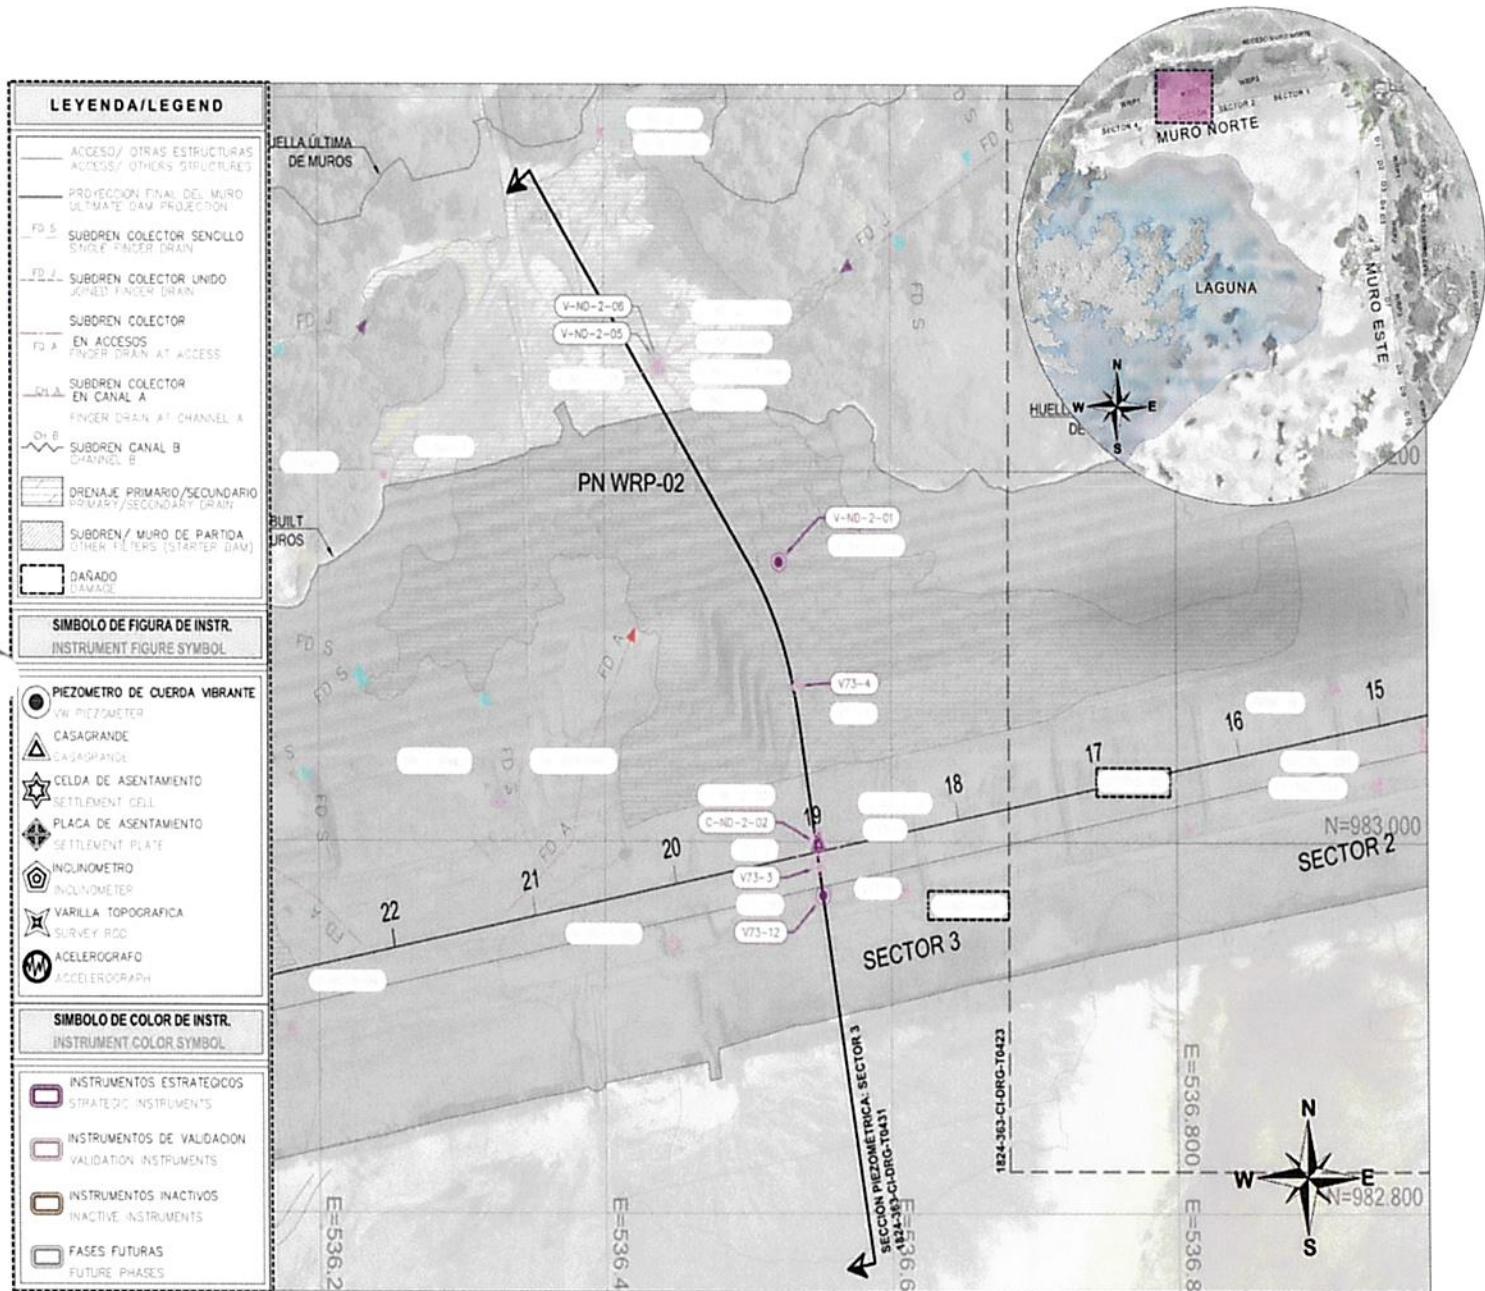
Vista de Planta en Muro Norte Sector 3 - WRP2 con Piezómetros
